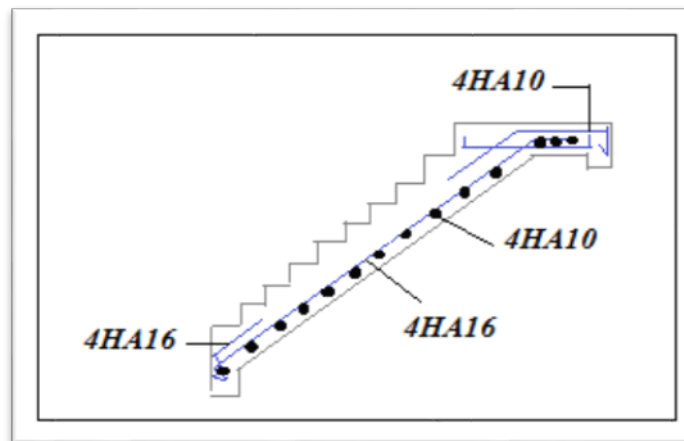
schéma de ferrailage d'escalier l'autres étages type 01 du volée 01
